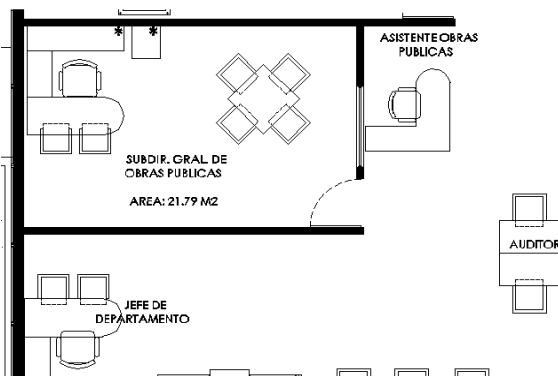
Vista en planta del Departamento de Obras Públicas. Autor: Eva Zavala
